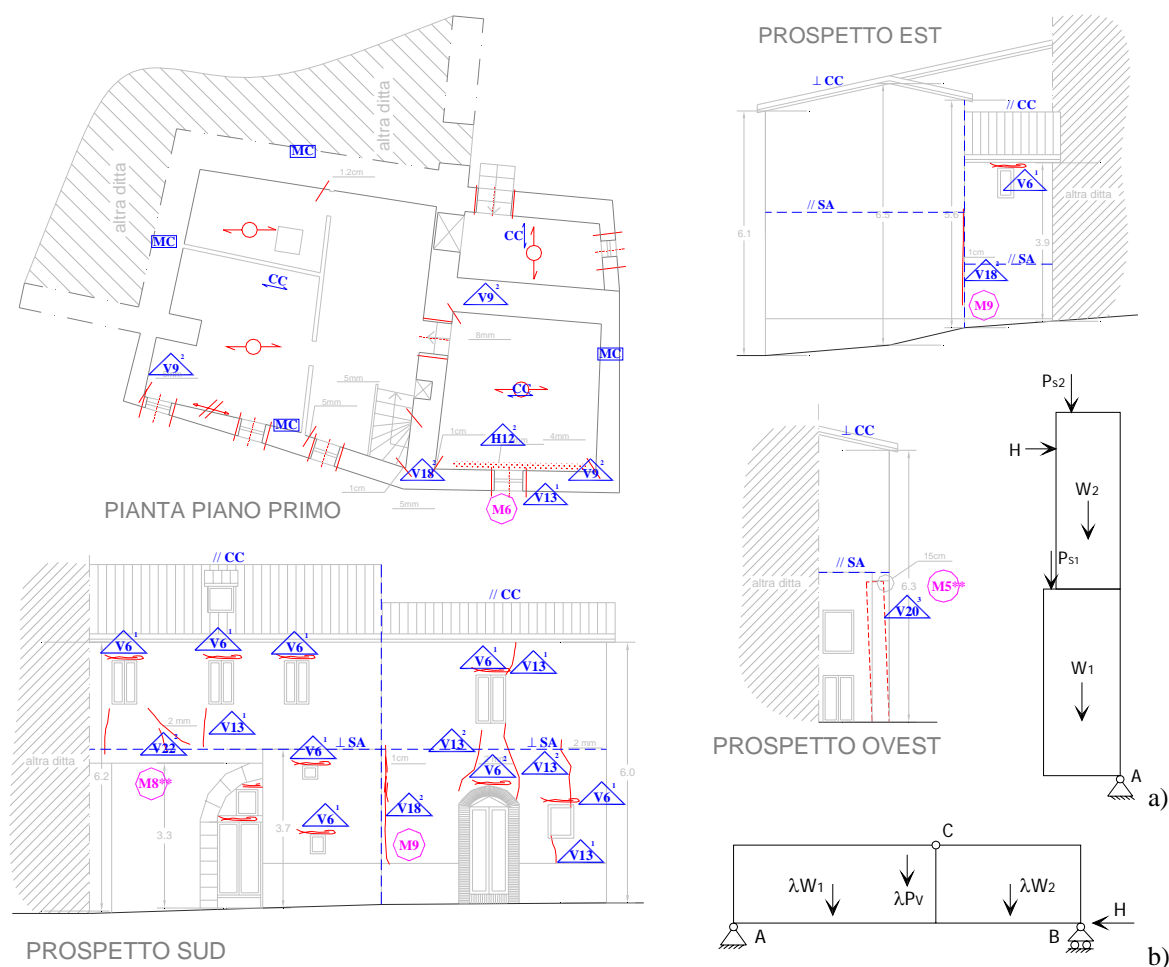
Dall'alto in senso orario: pianta del primo piano, prospetto del lato est ed ovest, schema di calcolo per la valutazione della reazione opposta dalla parete sul lato est alla spinta dell'effetto arco orizzontale nella parete sud, schema di calcolo per la valutazione della flessione orizzontale della facciata principale e prospetto sud dell'edificio.
